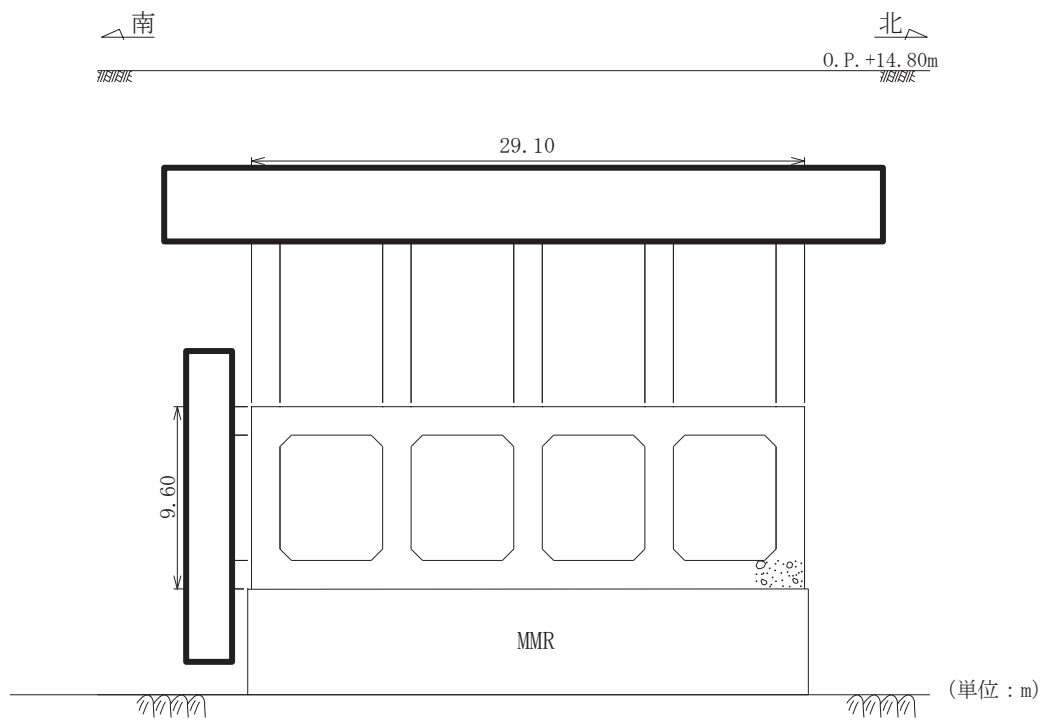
第 3 号機取水路断面図 (A-A 断面)
